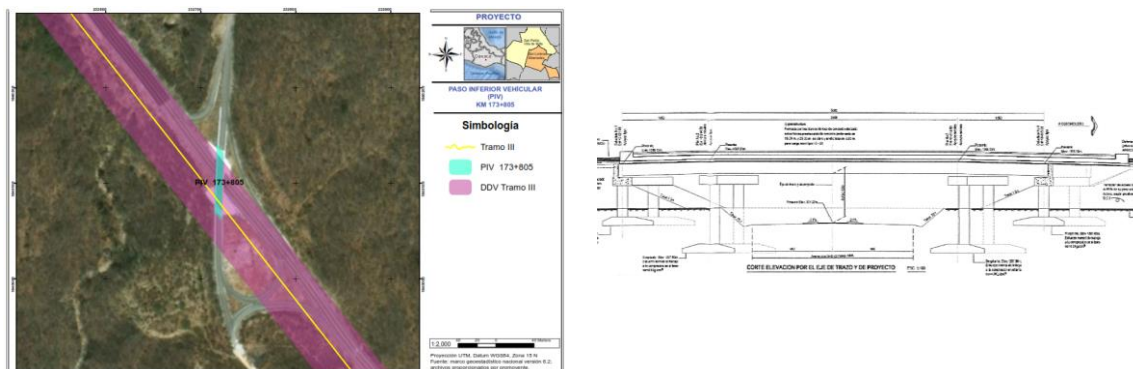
Proyecto en planta y corte longitudinal del PIV 173+805.
